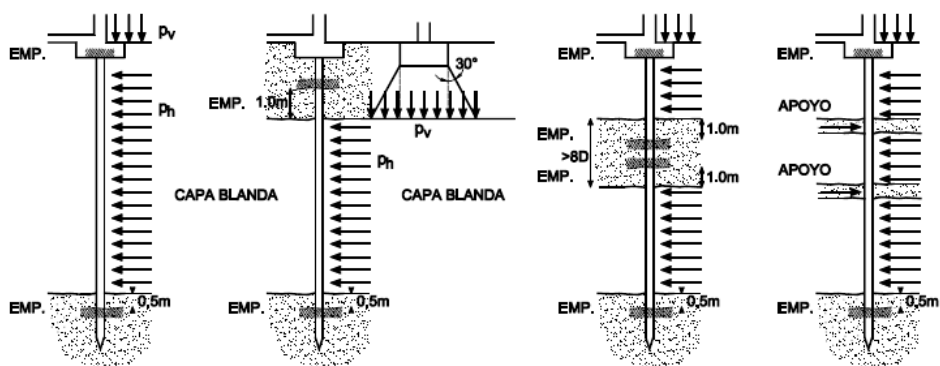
Condiciones de apoyo para el cálculo de esfuerzos horizontales en los pilotes²⁸
